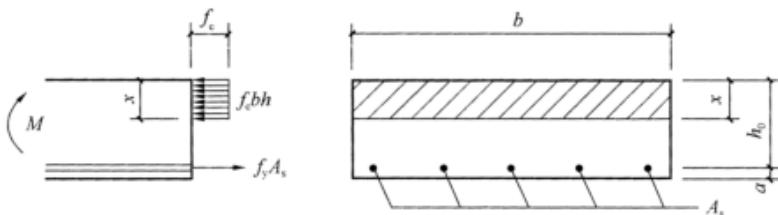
蒸压轻质混凝土墙板受弯正截面承载力计算简图
